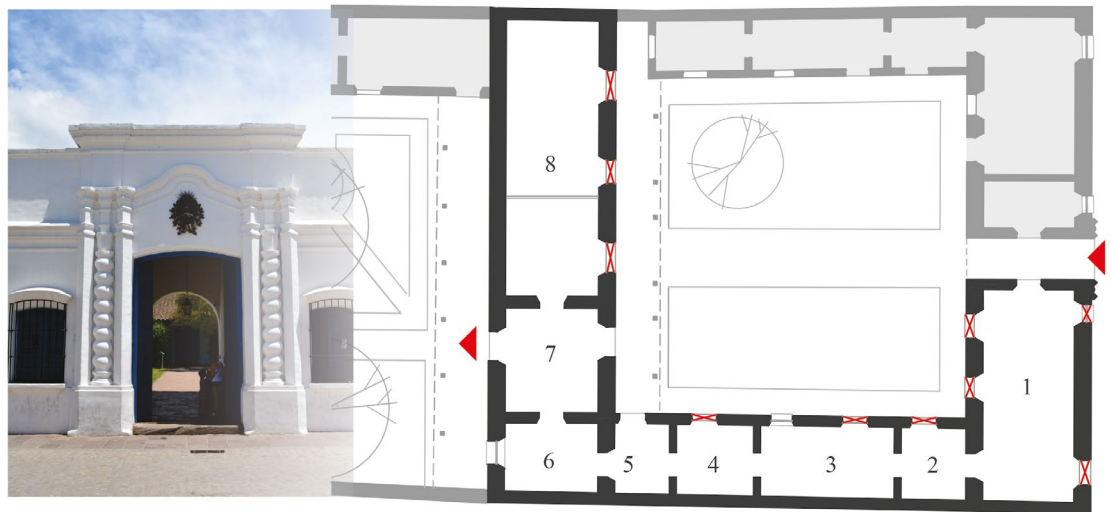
Planta y fachada del Museo Casa Histórica de la Independencia (Planimetría: Bazán y Ajmat; fotografía: Juan Ajmat, 2018).
